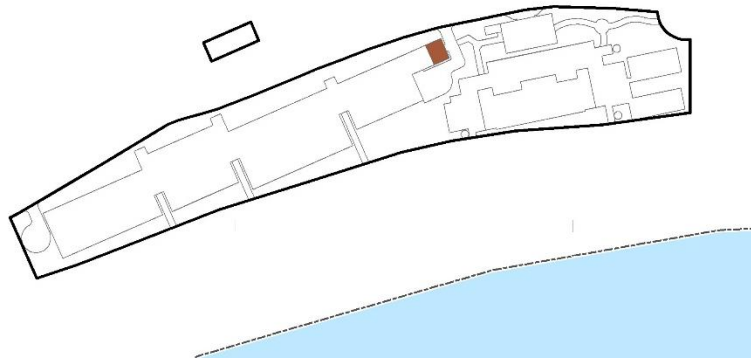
Ubicación de los baños y vestidores en la vista de conjunto del proyecto.
